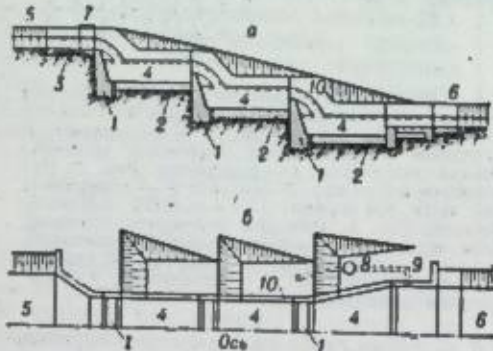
Ступенчатый открытый перепад: а — разрез по оси; б — план; 1 — стена падения; 2 — флитбет; 3 — понур; 4 — водобойный колодец; 5 — верхний бьеф; 6 — нижний бьеф; 7 — служебный мостик; 8 — смотровой колодец; 9 — дренаж; 10 — продольная стена.
